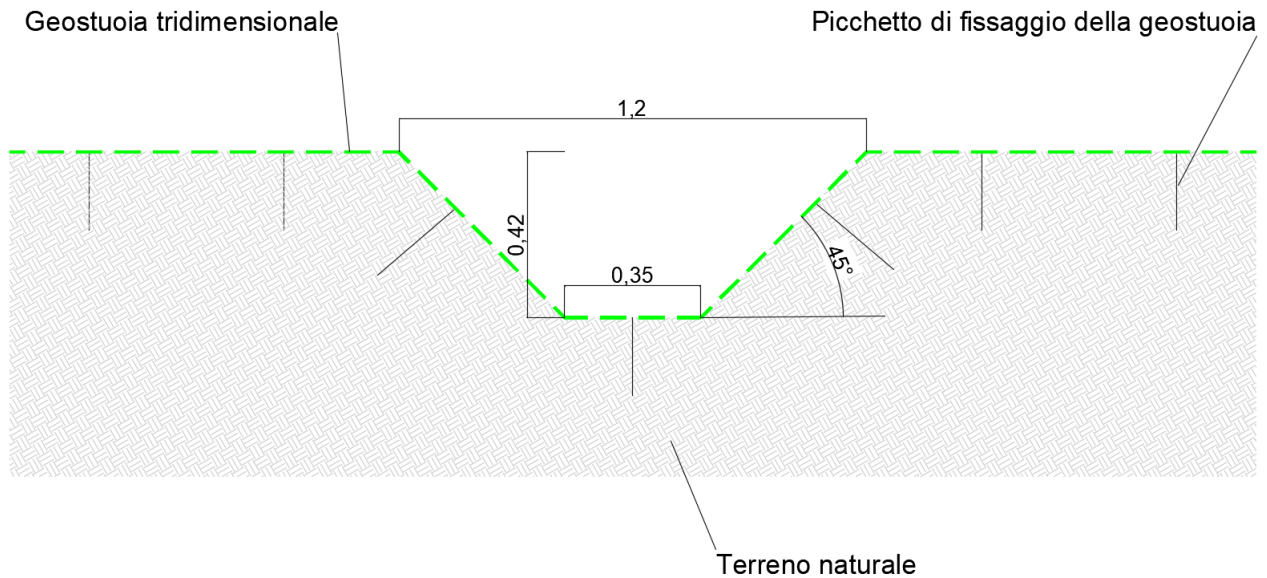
Sezione di drenaggio – Canale trapezoidale in terra
